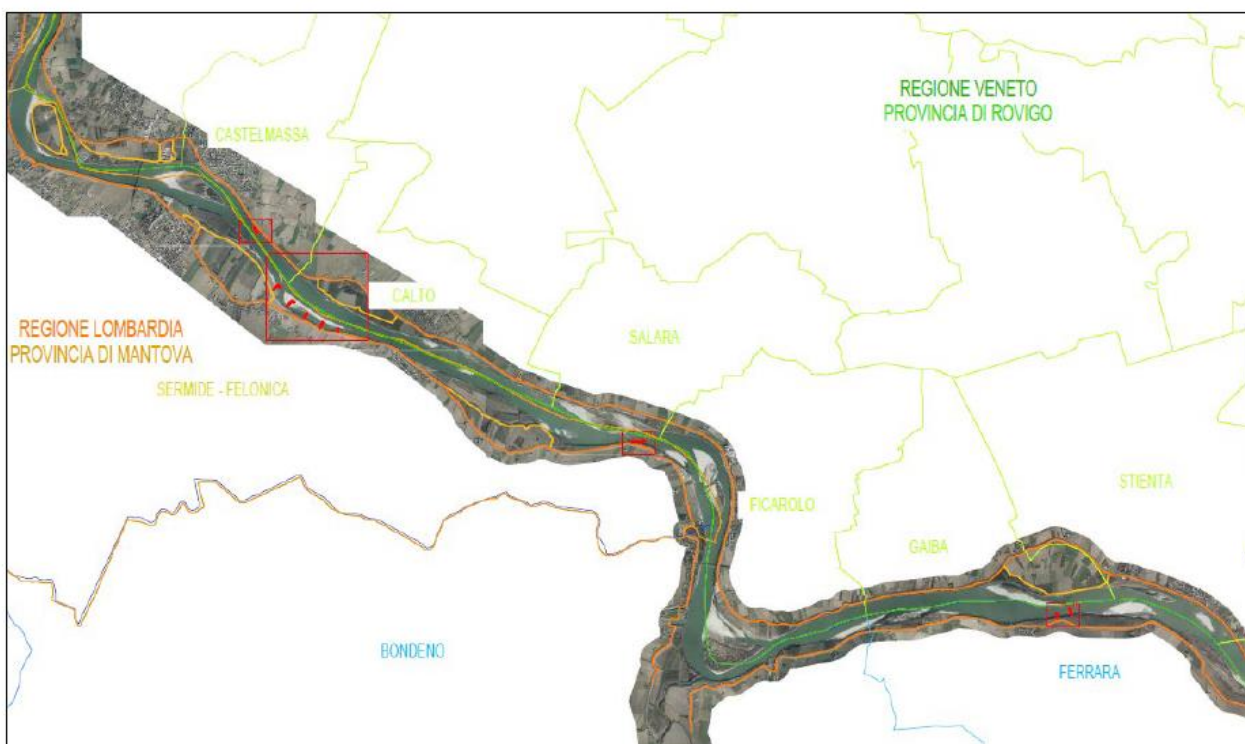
Planimetria interventi stralcio FE-E-7-NI
